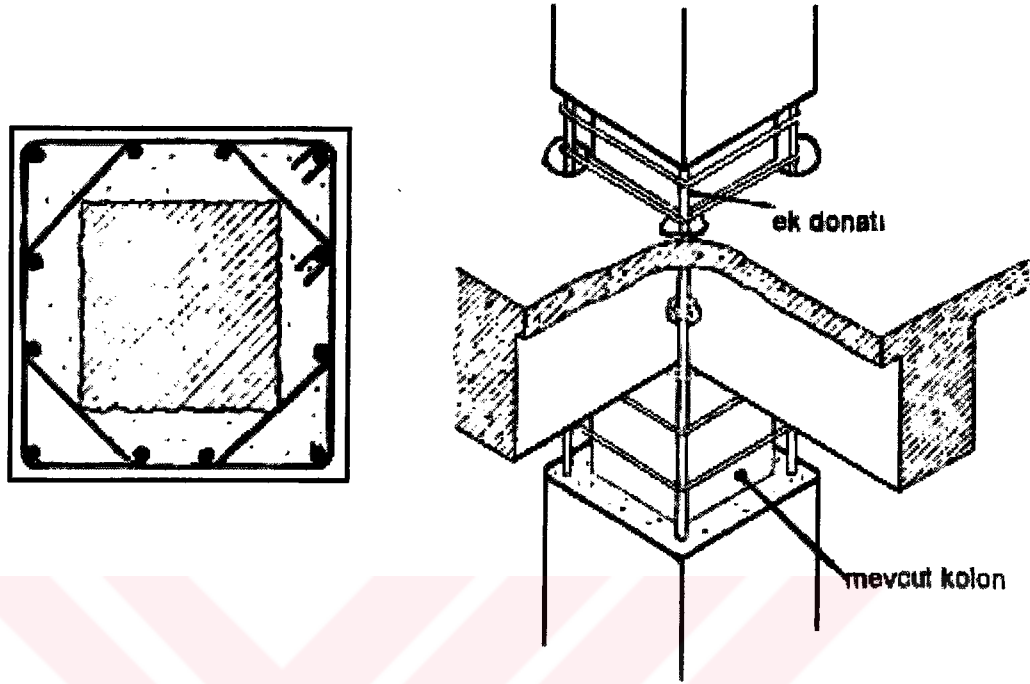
Kolonun yeni donatı eklenmesi ile onarılması
